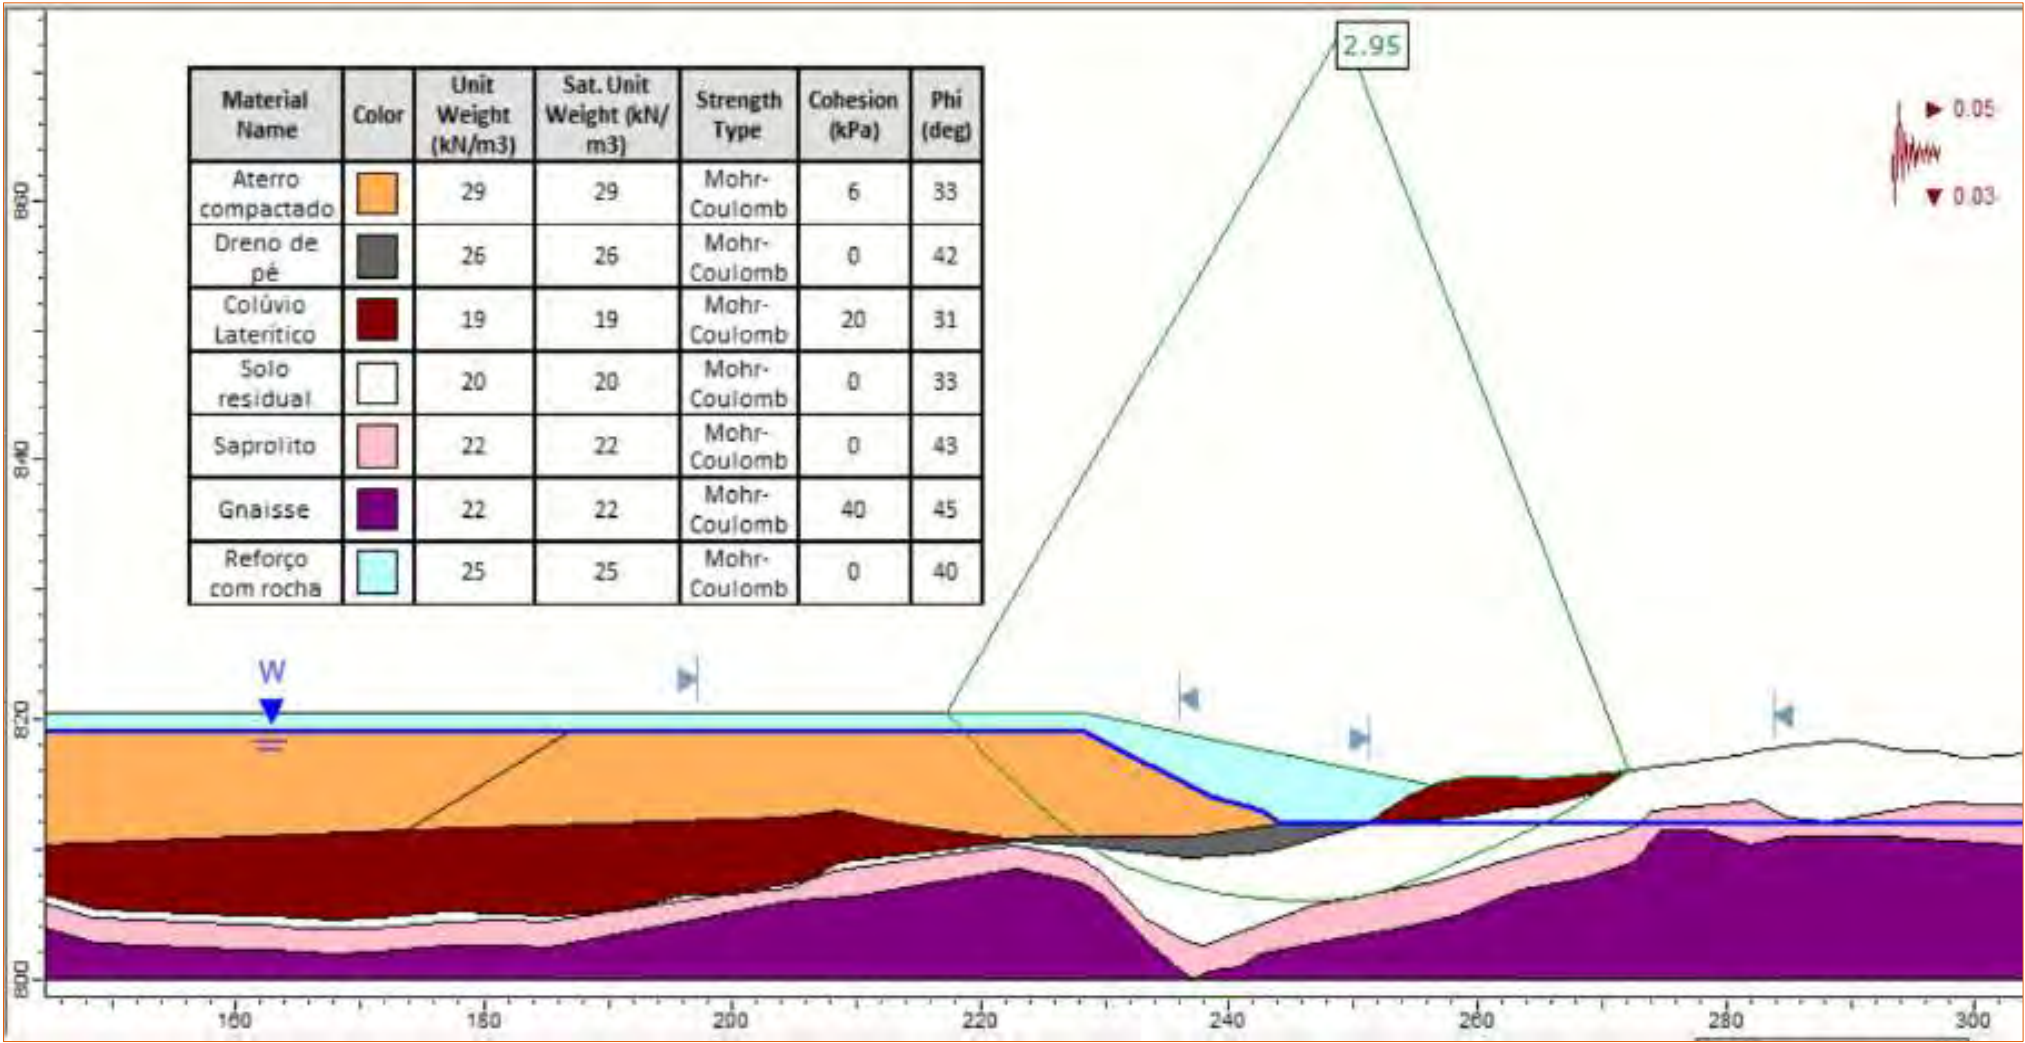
Seção A-A - Condição Pseudo-Estática (Solo residual drenado) - Superfície não circular - FS = 2,95.
